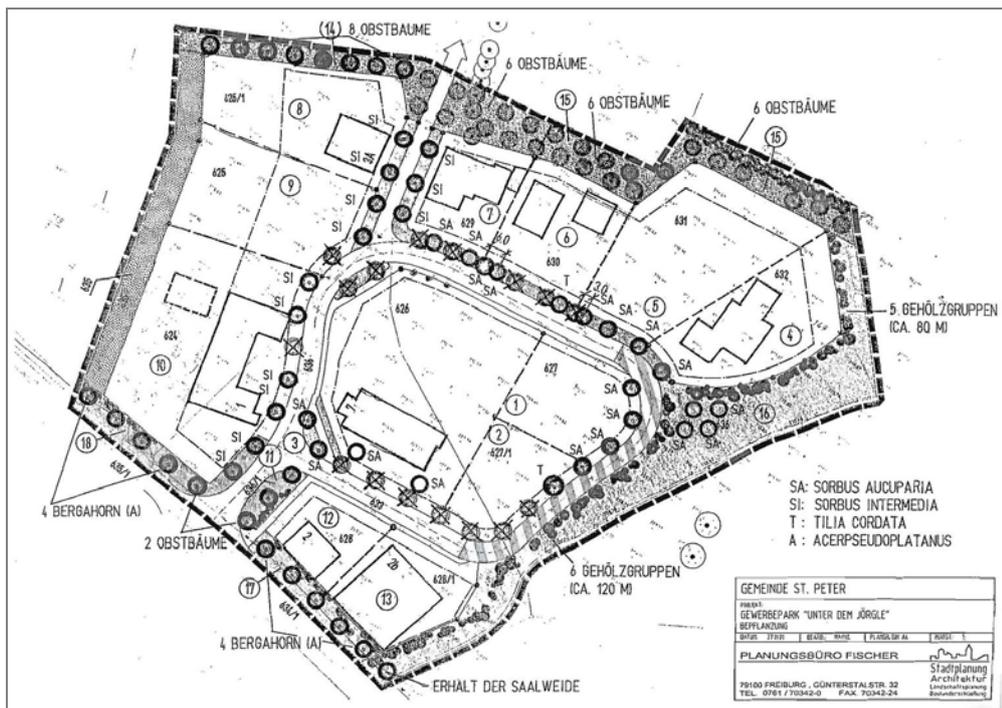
Wall mit standortgerechter Bepflanzung?
